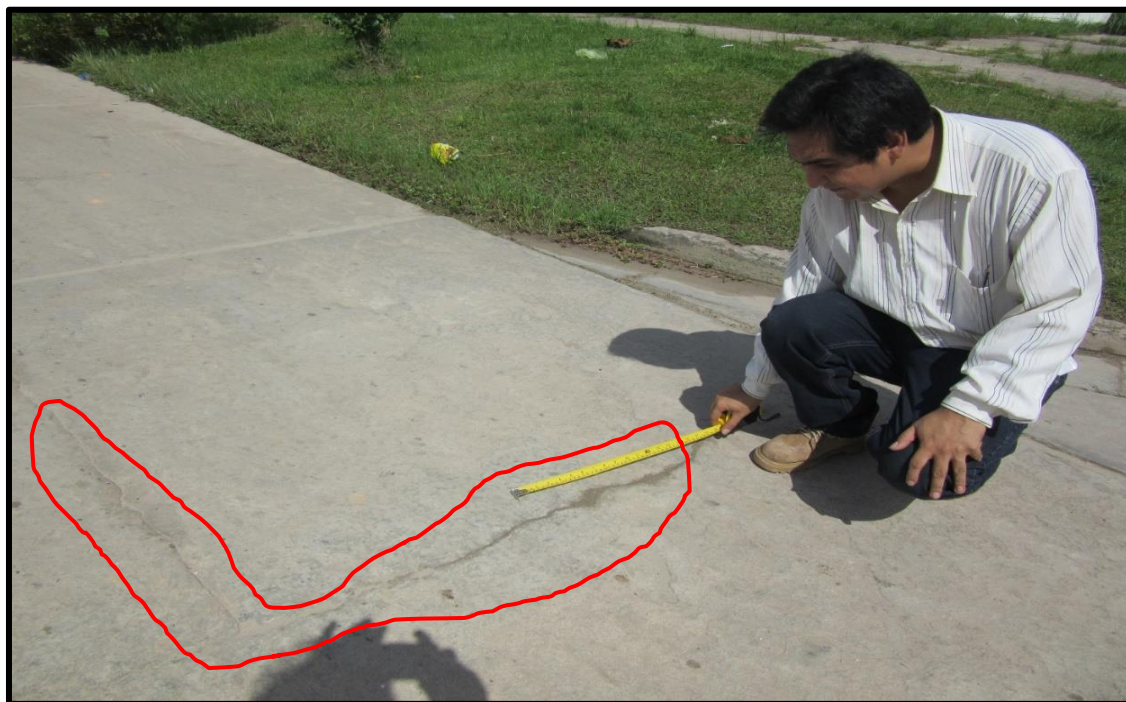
En la vista se observa Fisuras de Grieta Lineal Longitudinal y Transversal del pavimento de media Severidad en el Jirón Trujillo 14va. Cuadra
